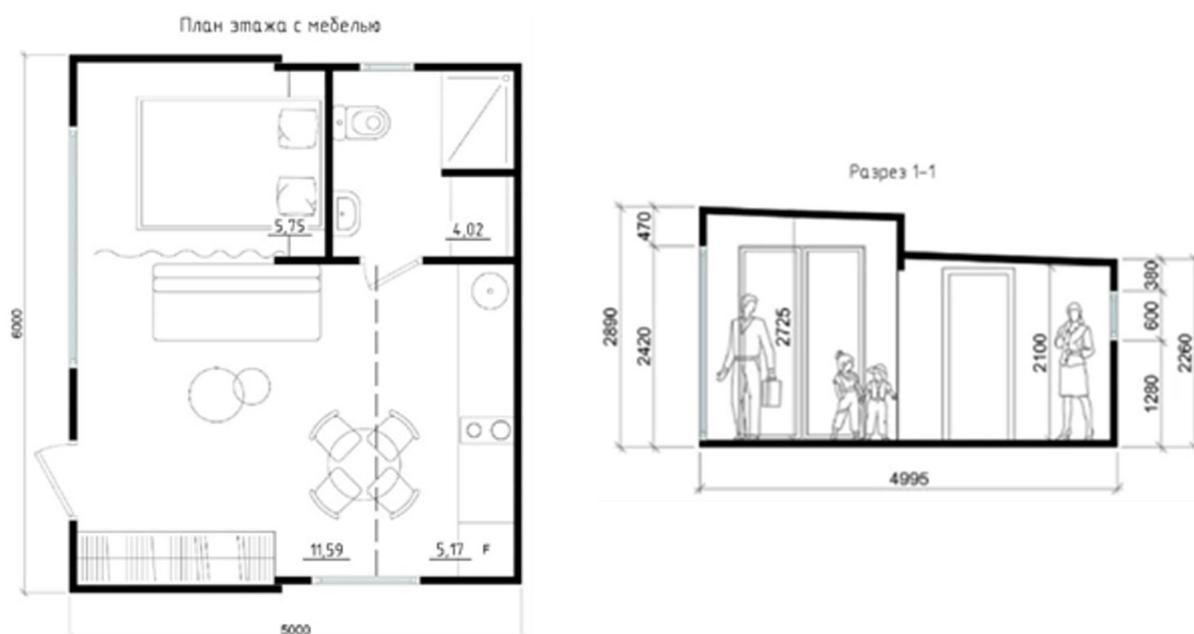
План этажа с мебелью и поперечный разрез здания
